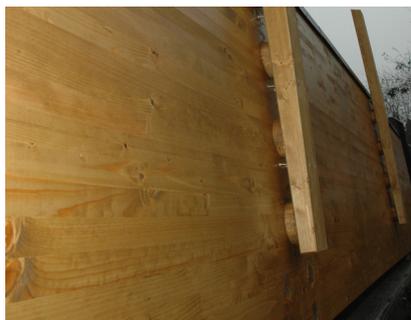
Per evitare il contatto e favorire il deflusso dell'acqua piovana, fra i montanti del parapetto e la travata principale sono interposte delle rondelle di legno.
